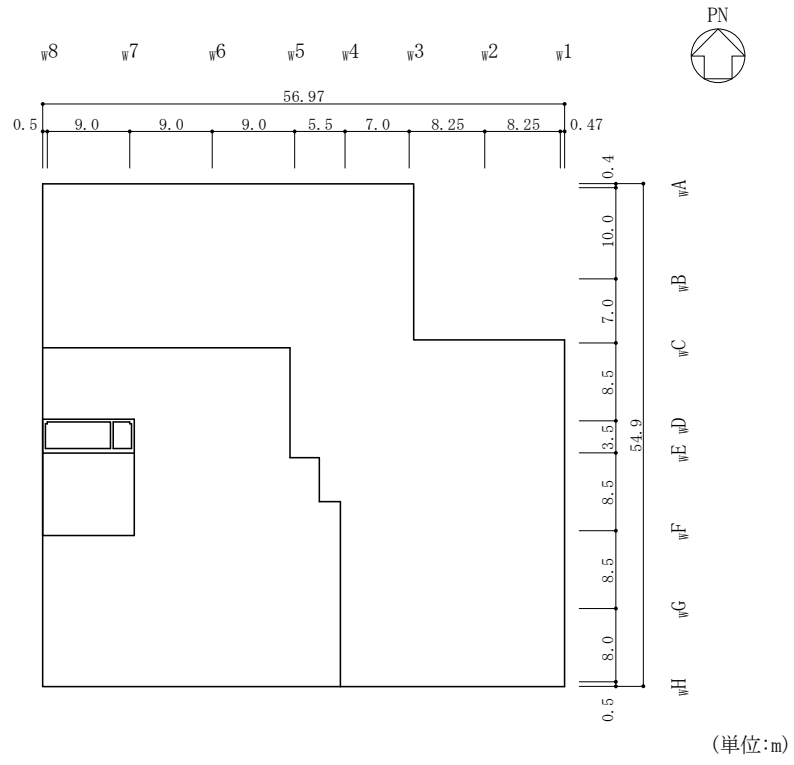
(9) 廃棄物処理建物の概略平面図 (EL 42.0m)
